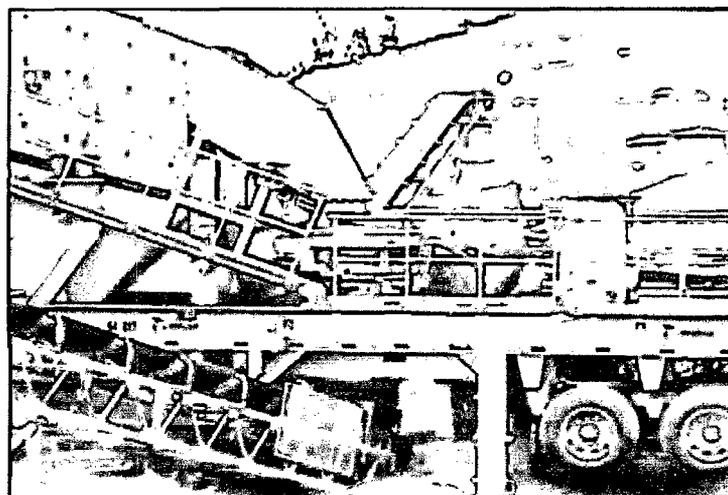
Esquema del montaje de planta móvil de trituración y zarandeo
